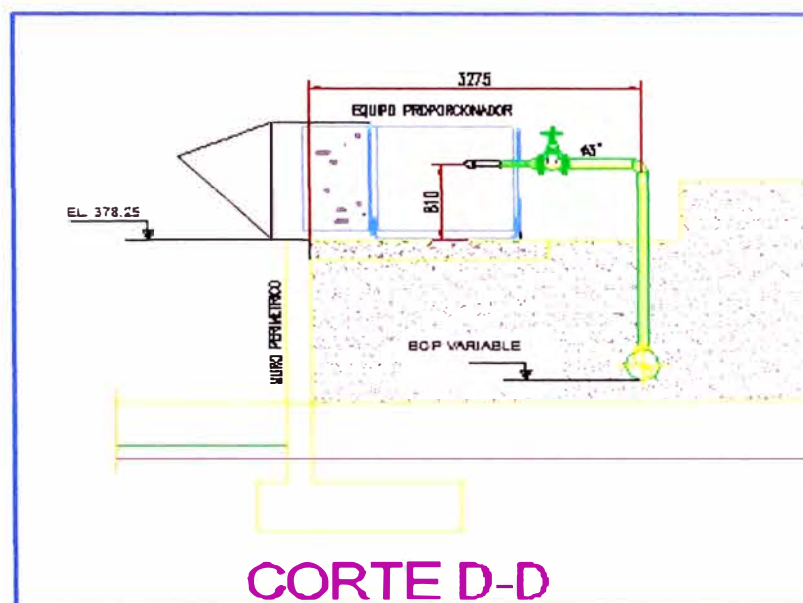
GENERADOR DE ESPUMA – Sobre Losa de Concreto.
